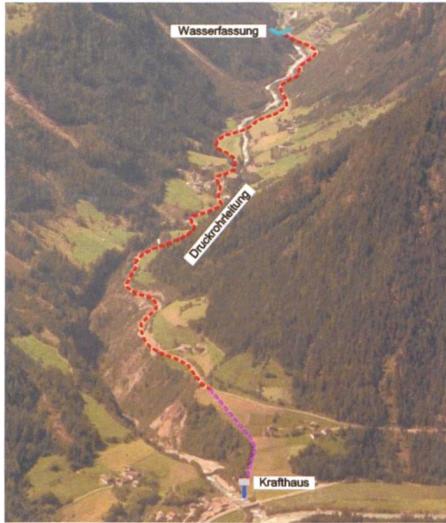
KW Schwarzach: Luftbild mit den drei Baulosen.
